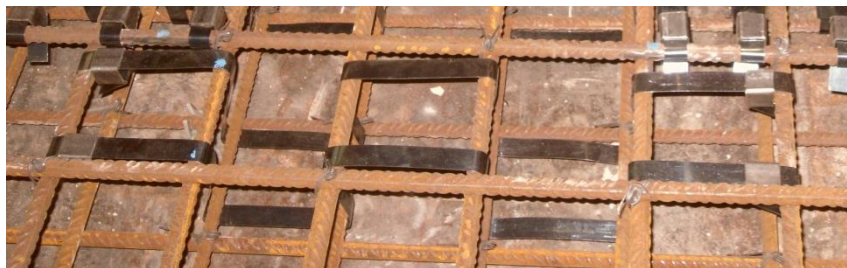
Shear bands* instaladas na armadura longitudinal
